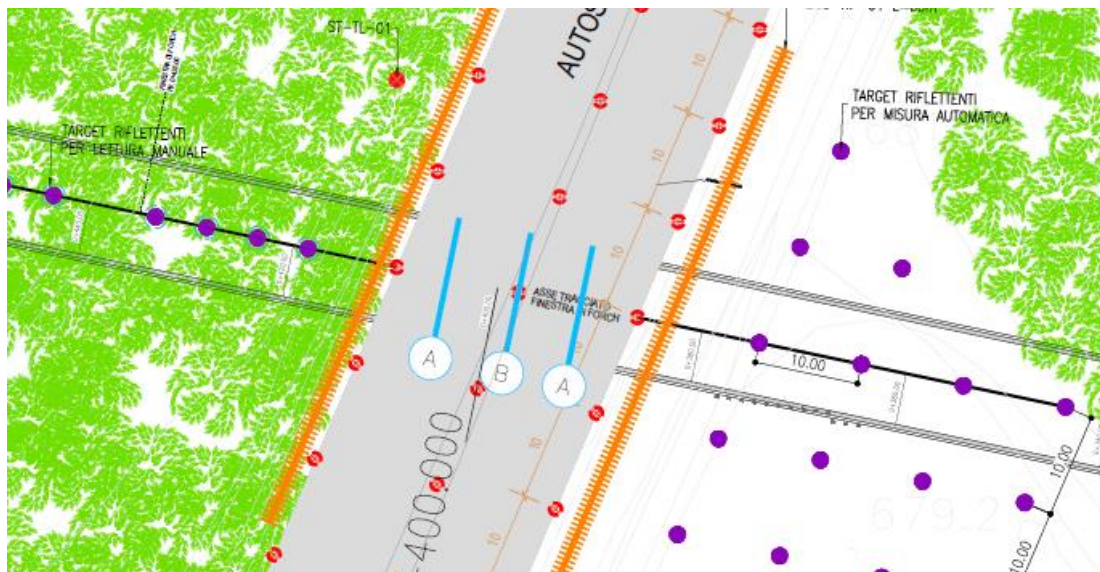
Monitoraggio A22 Finestra di Forch – stralcio planimetrico tavole del monitoraggio)
